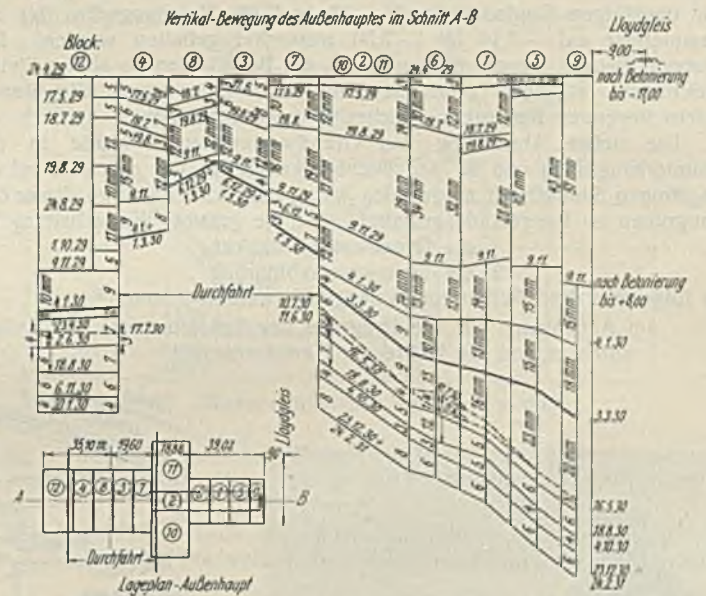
Bewegung der Außenhauptblöcke im Längsschnitt.
